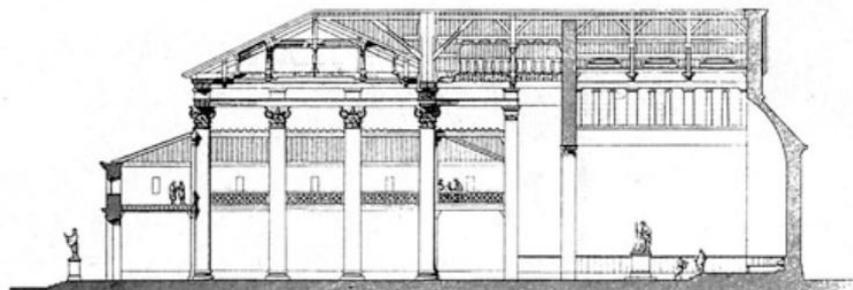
Interpretación de la basílica de Fano en sección (Viollet Le Duc, 1863)
